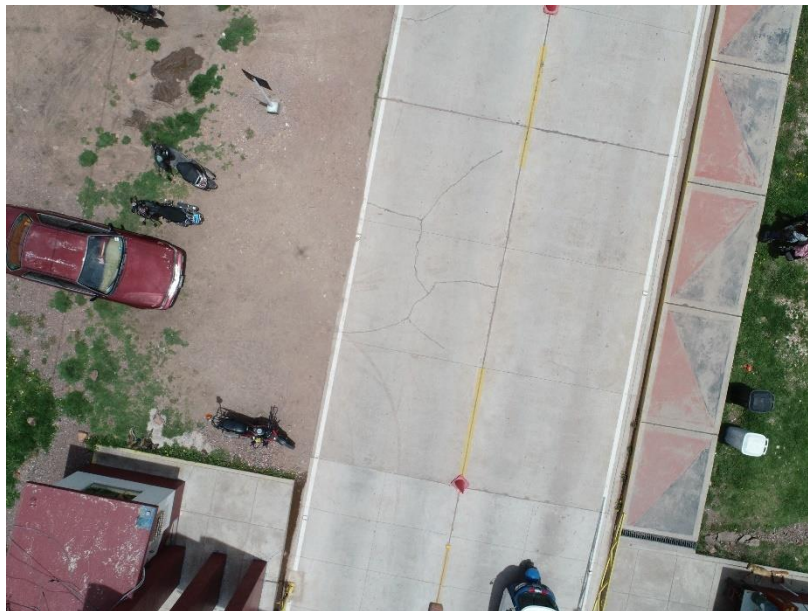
Fisuras en pavimento ASSHTO  $e=0.20\text{m}$
